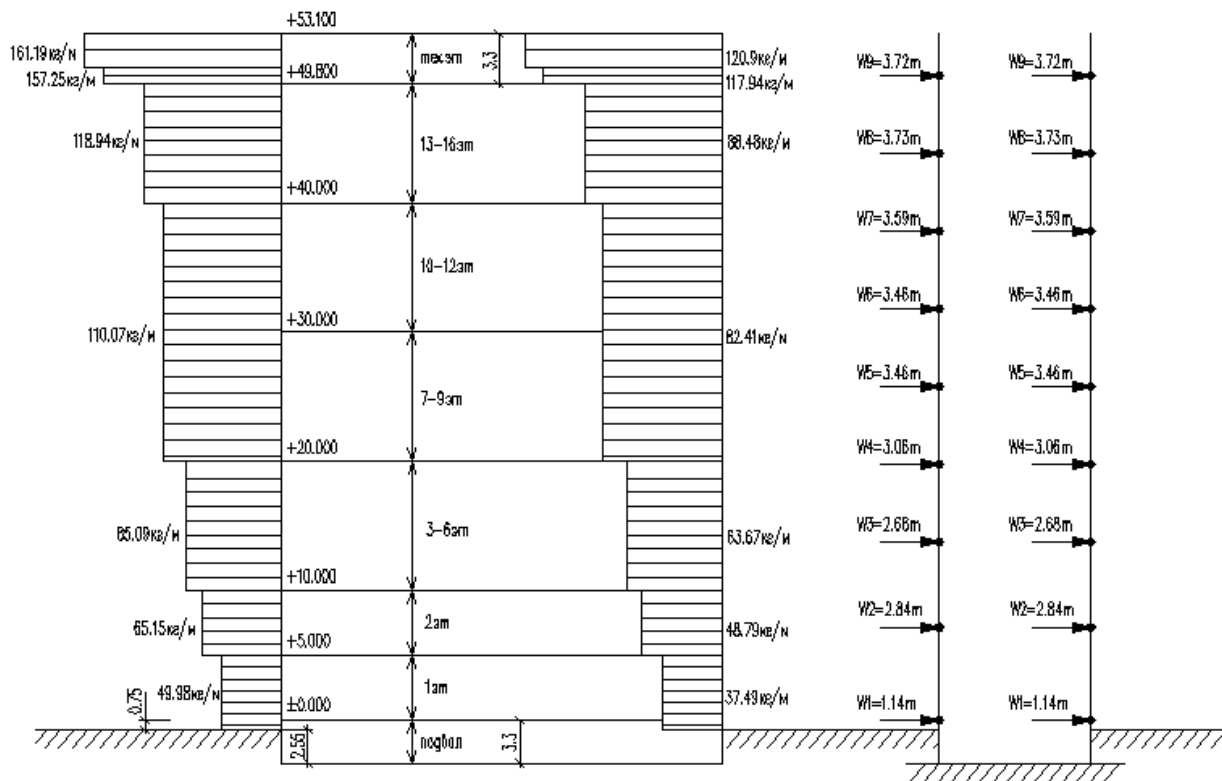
Схема приложения узловой ветровой нагрузки поперек здания (загружение 5)
